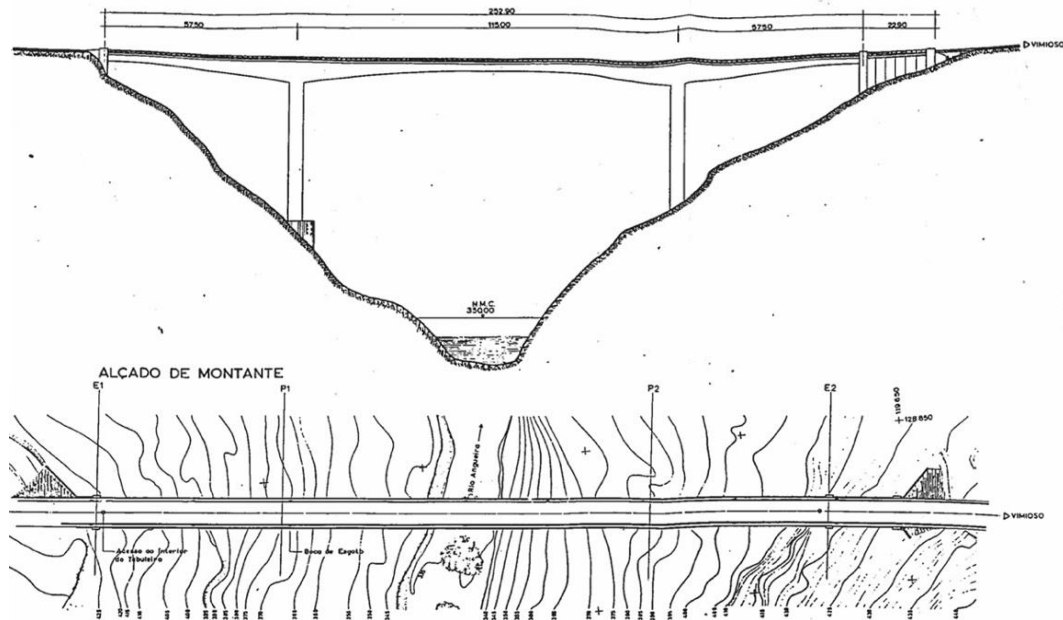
Esquema em alçado e planta da ponte sobre o Rio Angueira.
